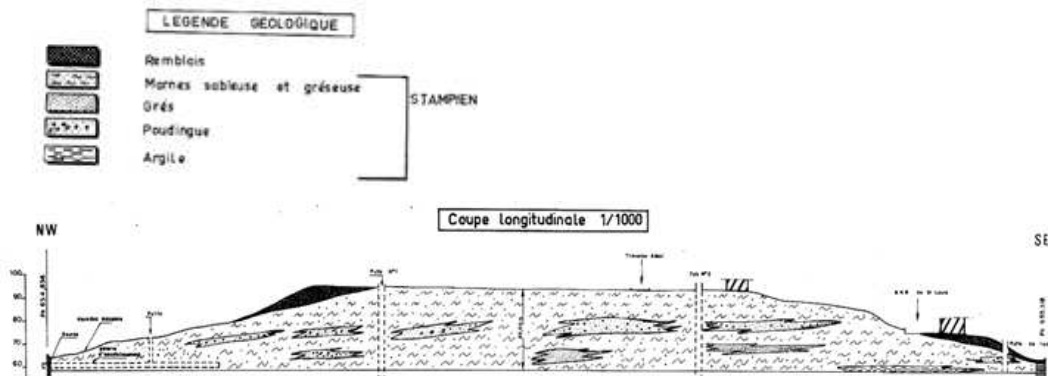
Coupe longitudinale du tunnel de Saint Louis
